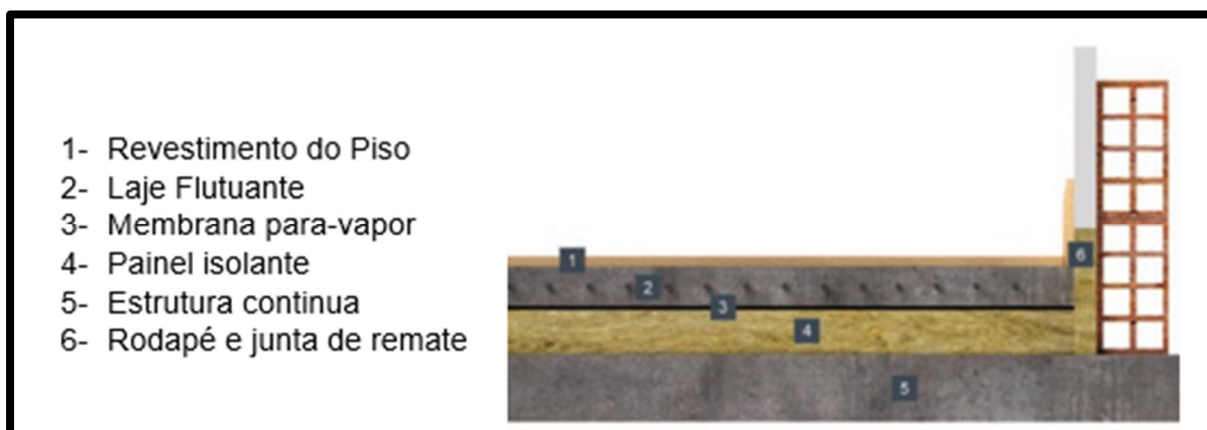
Exemplo Imperialum - Pavimento sobre espaço interior
